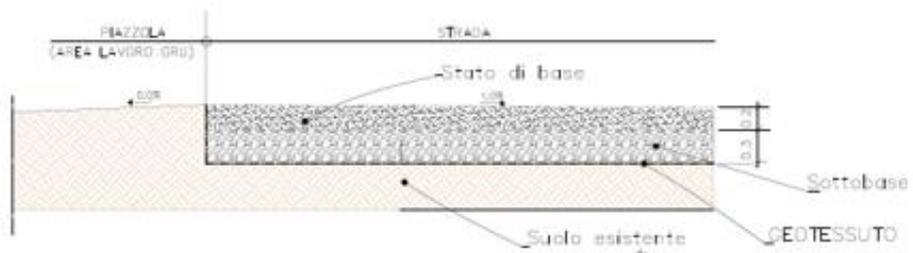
Sezione della piazzola (configurazione completa) in fase di cantiere
